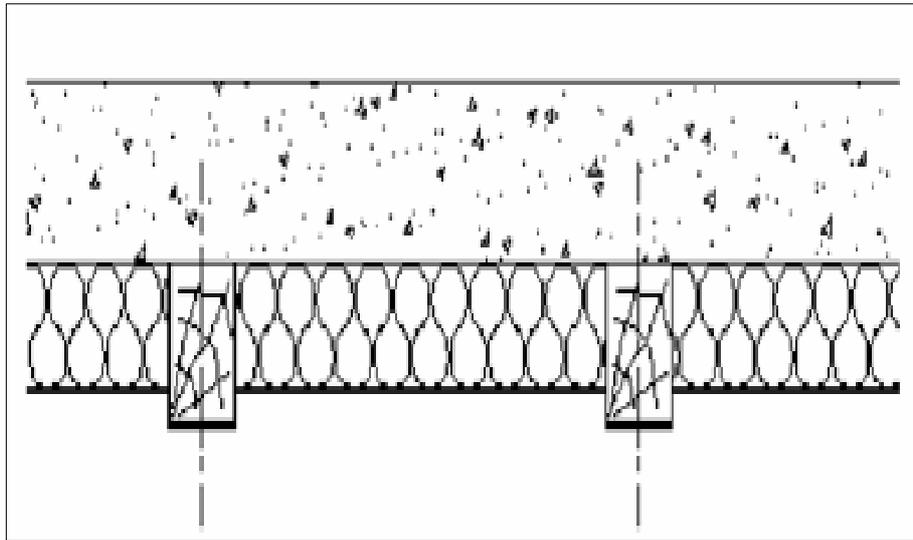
Colocación de aislamiento entre estructura que recibe revestimiento que esta fija al muro.
